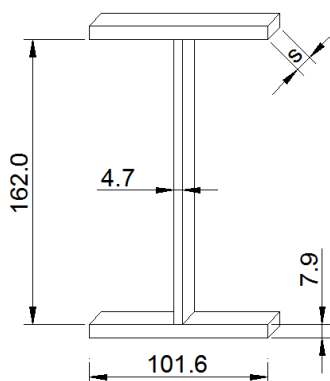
Perfil “I” utilizado como armadura de cisalhamento (TRAUTWEIN, 2006).
